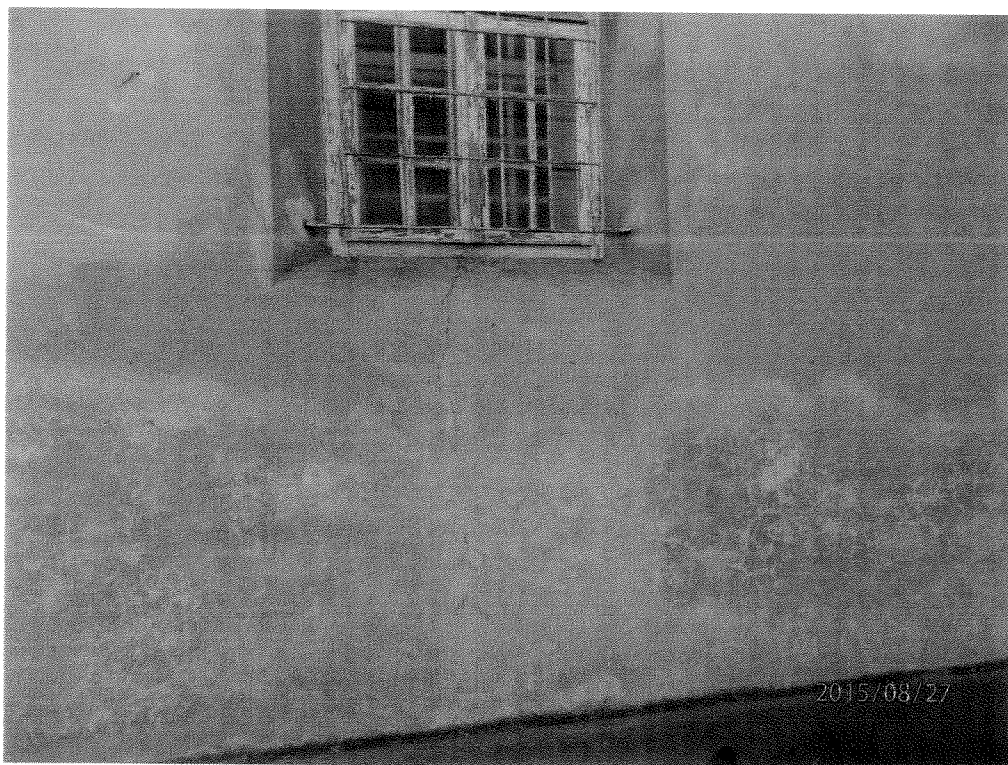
Zawilgocenia i rysy w narożniku północno wschodnim elewacji.
